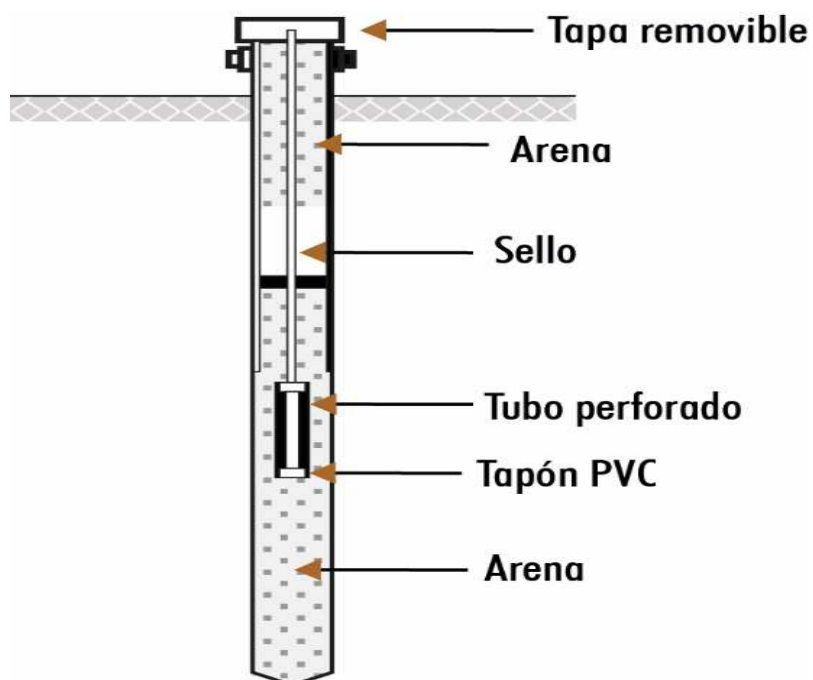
Esquema de instalación del piezómetro de cabeza abierta
